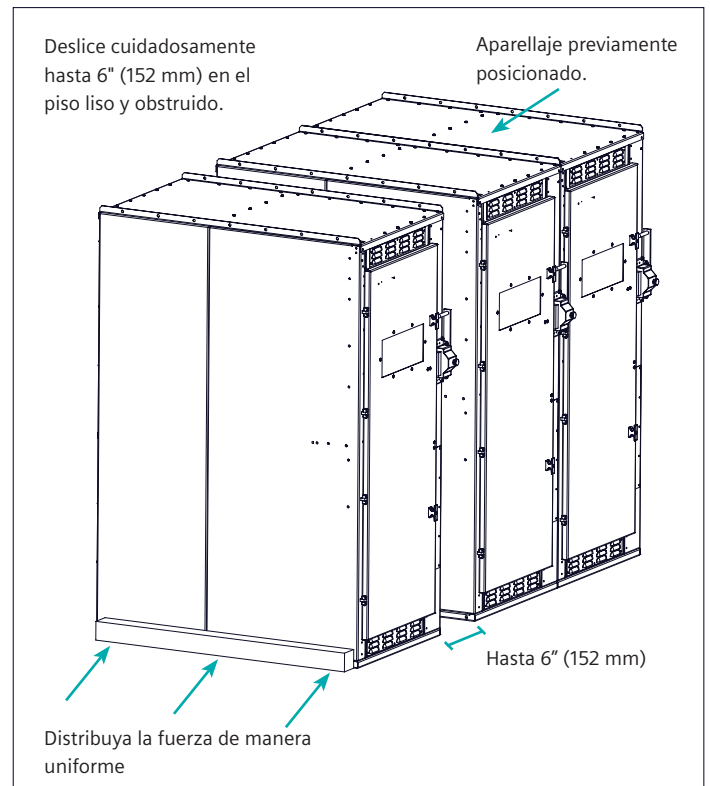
Desplazamiento del aparellaje de exterior SIEBREAK en zona obstruida sin grúa o para el posicionamiento final
